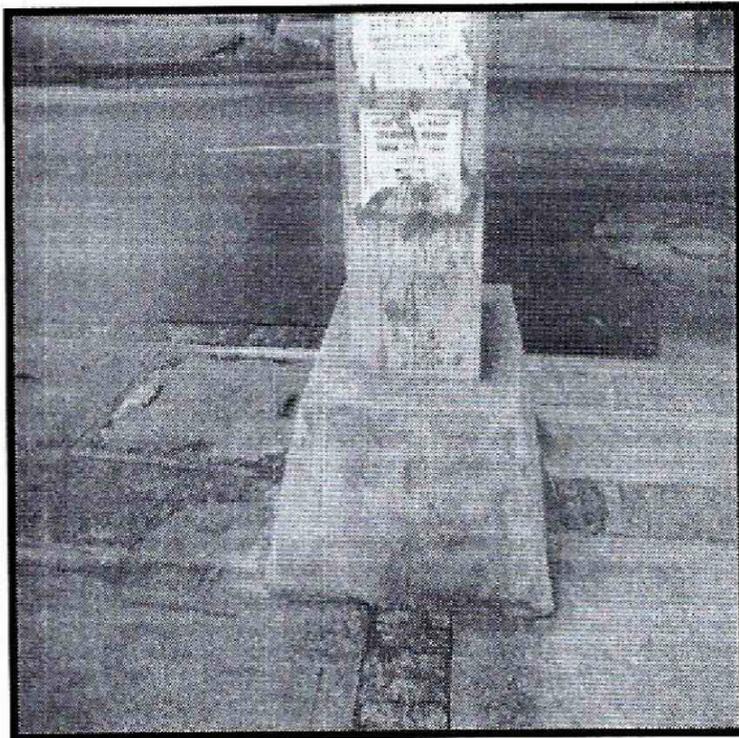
Escalera en concreto sobre el sendero peatonal del costado norte.
